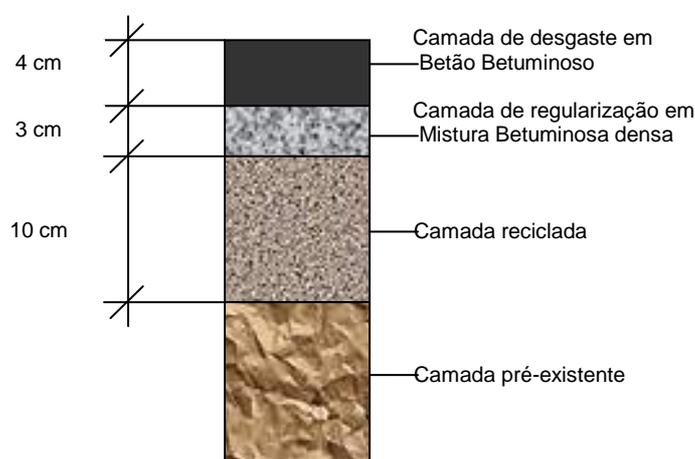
Estrutura final do pavimento reabilitado (EN 254 / Aguiar–Viana do Alentejo)
